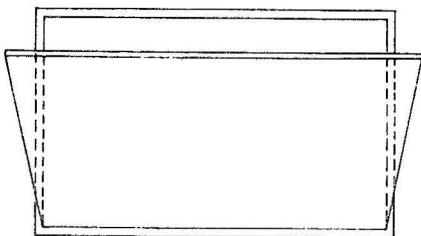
Fenêtre à vantail sur axe horizontal inférieur (ouvrante vers l'intérieur)
